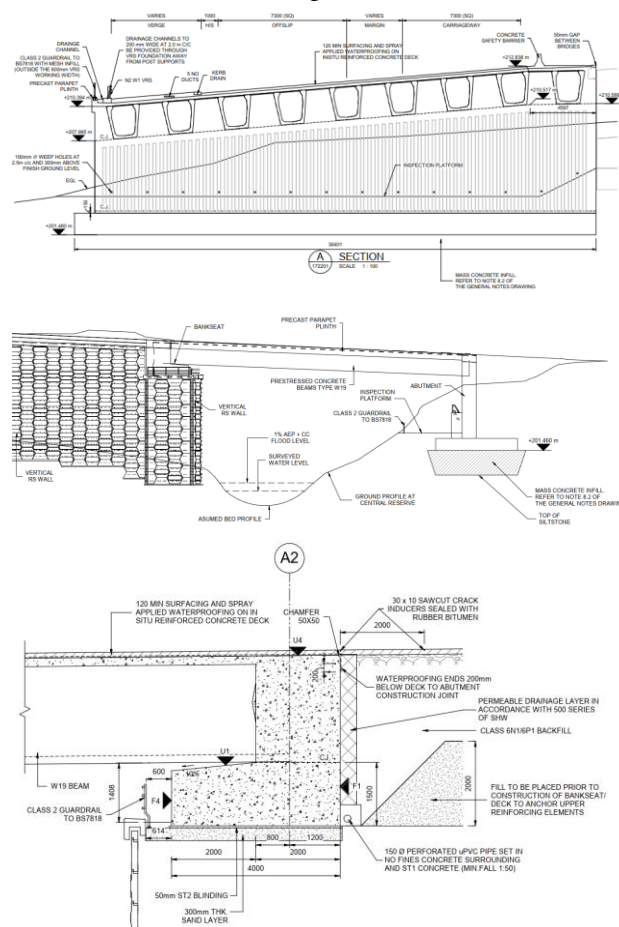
Estructura 540-NMWB. Estribo sur cerrado sobre roca. Norte: cargadero sobre suelo reforzado.
